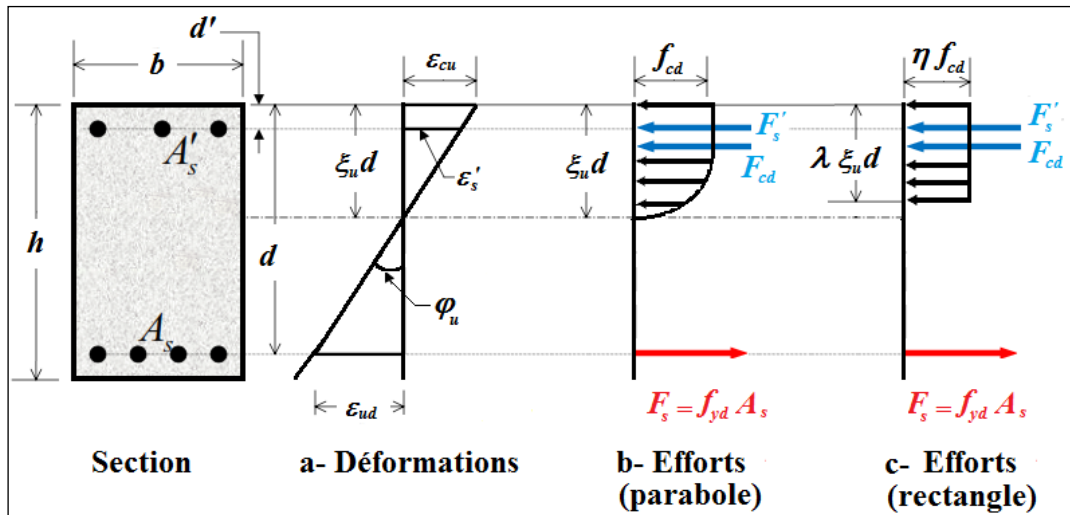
Comportement d'une section de poutre en béton armé fléchi à l'état limite ultime.
